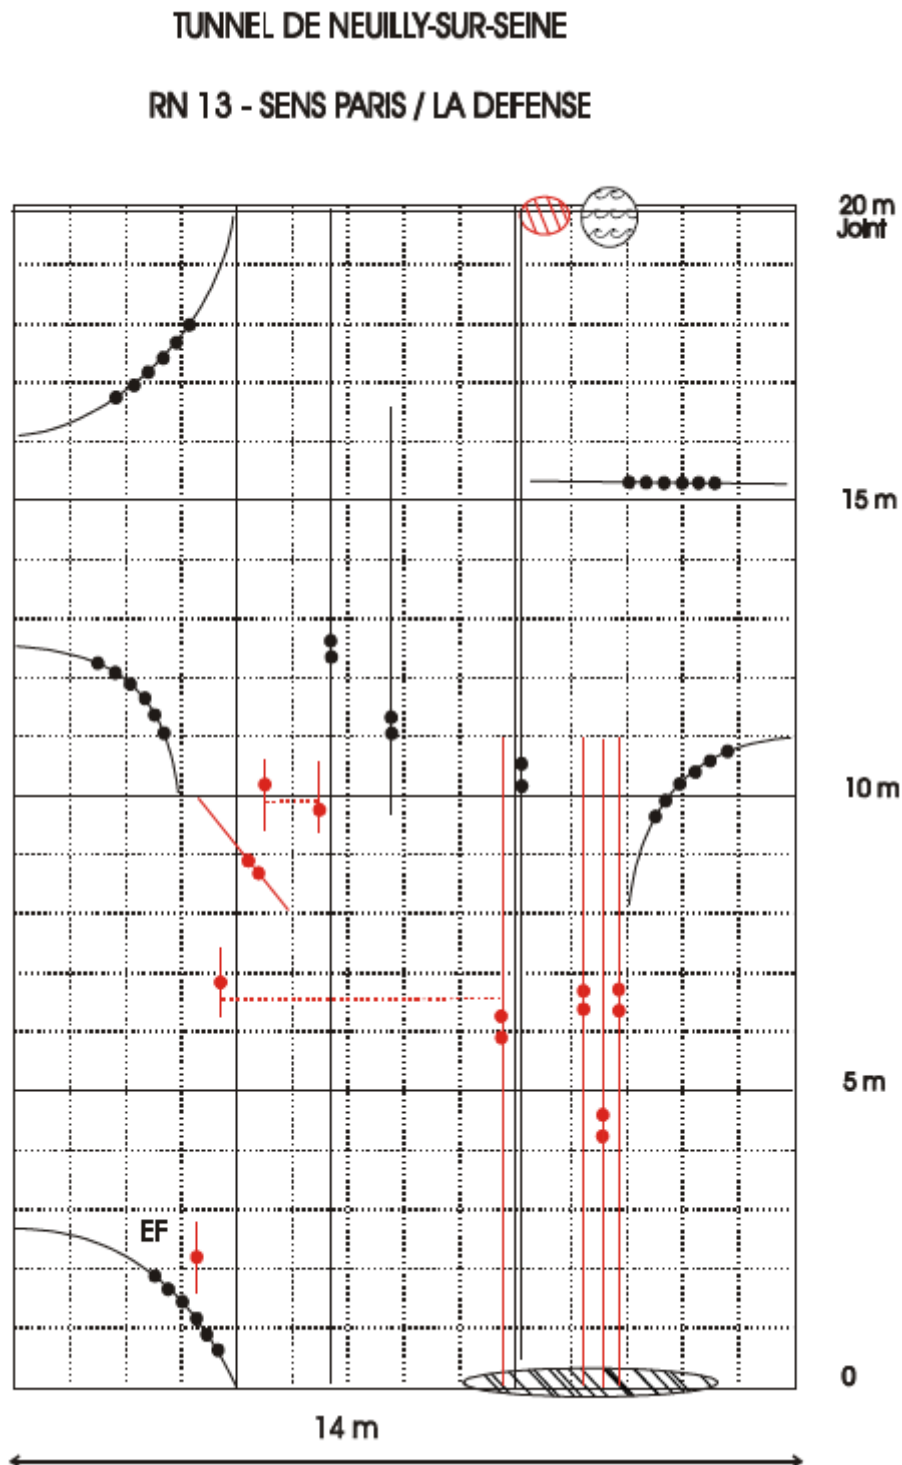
Planche de fissuration travée Nord Zone 1
